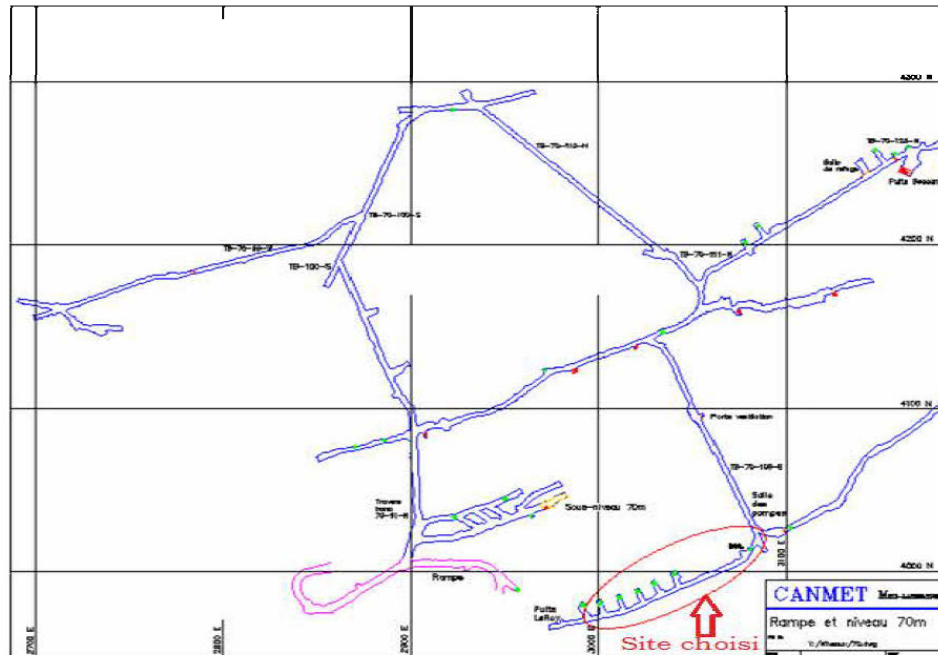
Plan du niveau 70 m et le site choisi pour la campagne de mesures.
